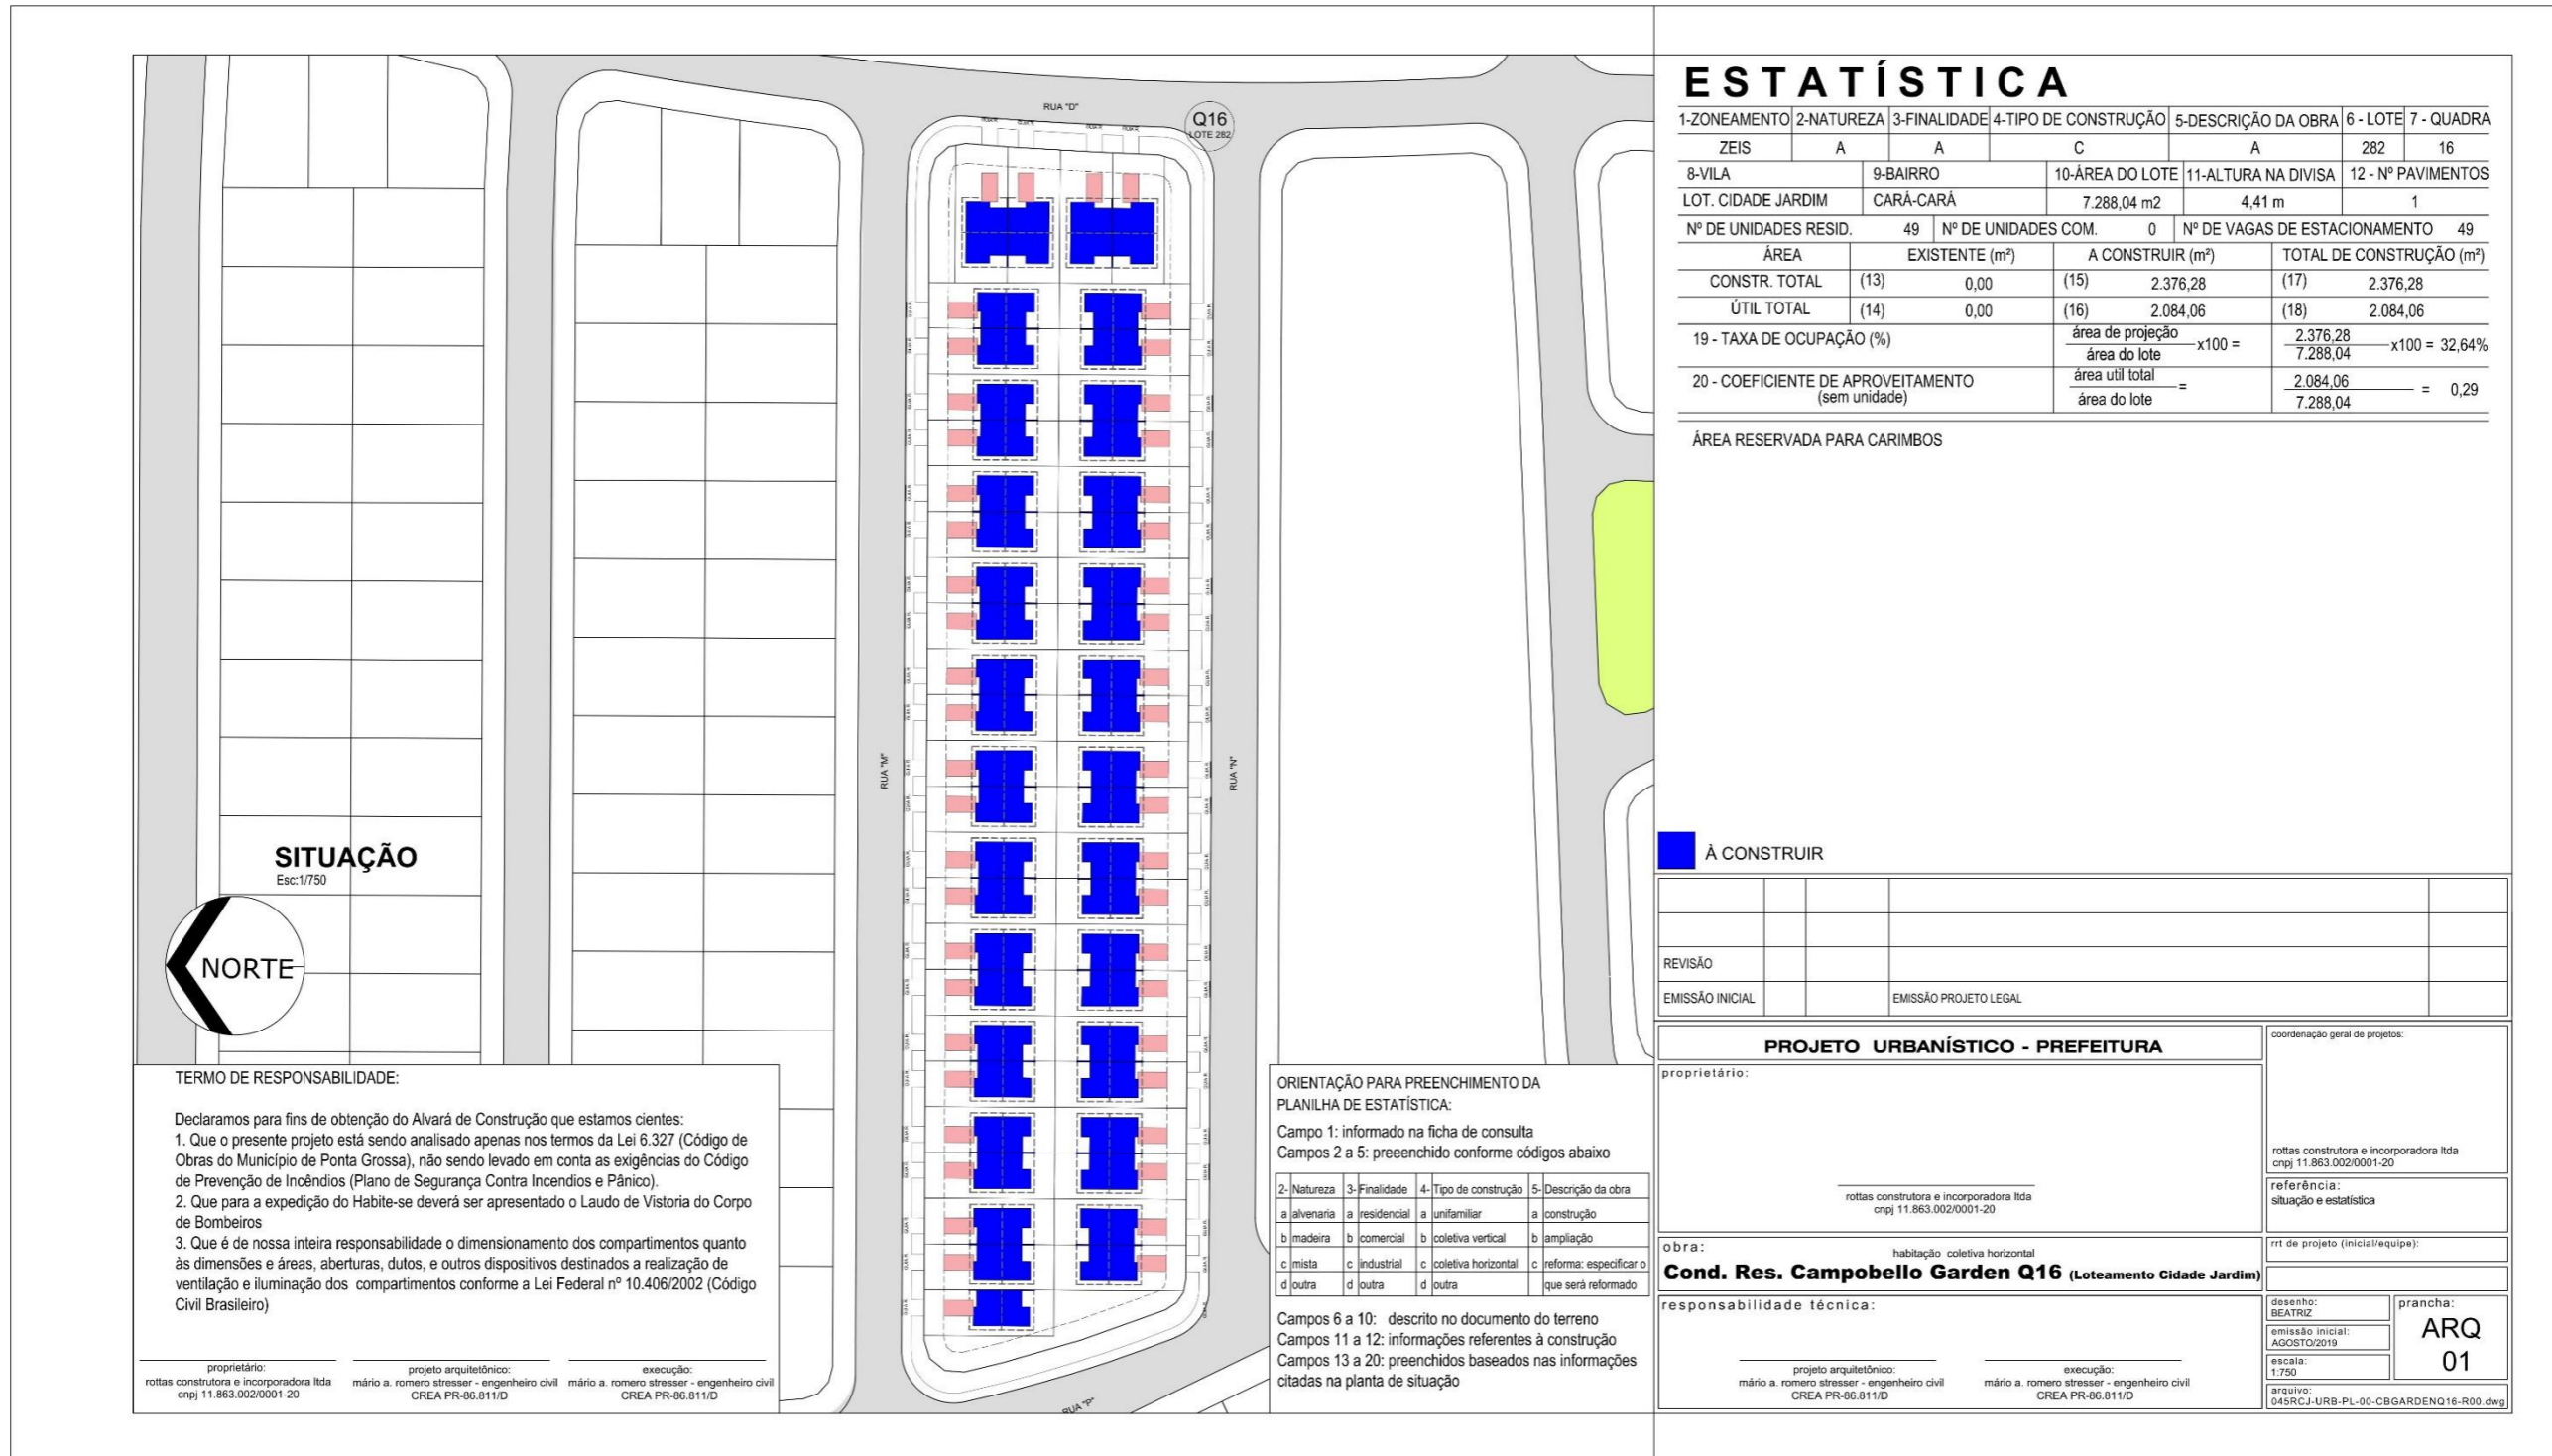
Projeto Urbanístico – Planta de Situação da Quadra 16 (Prancha 01).
